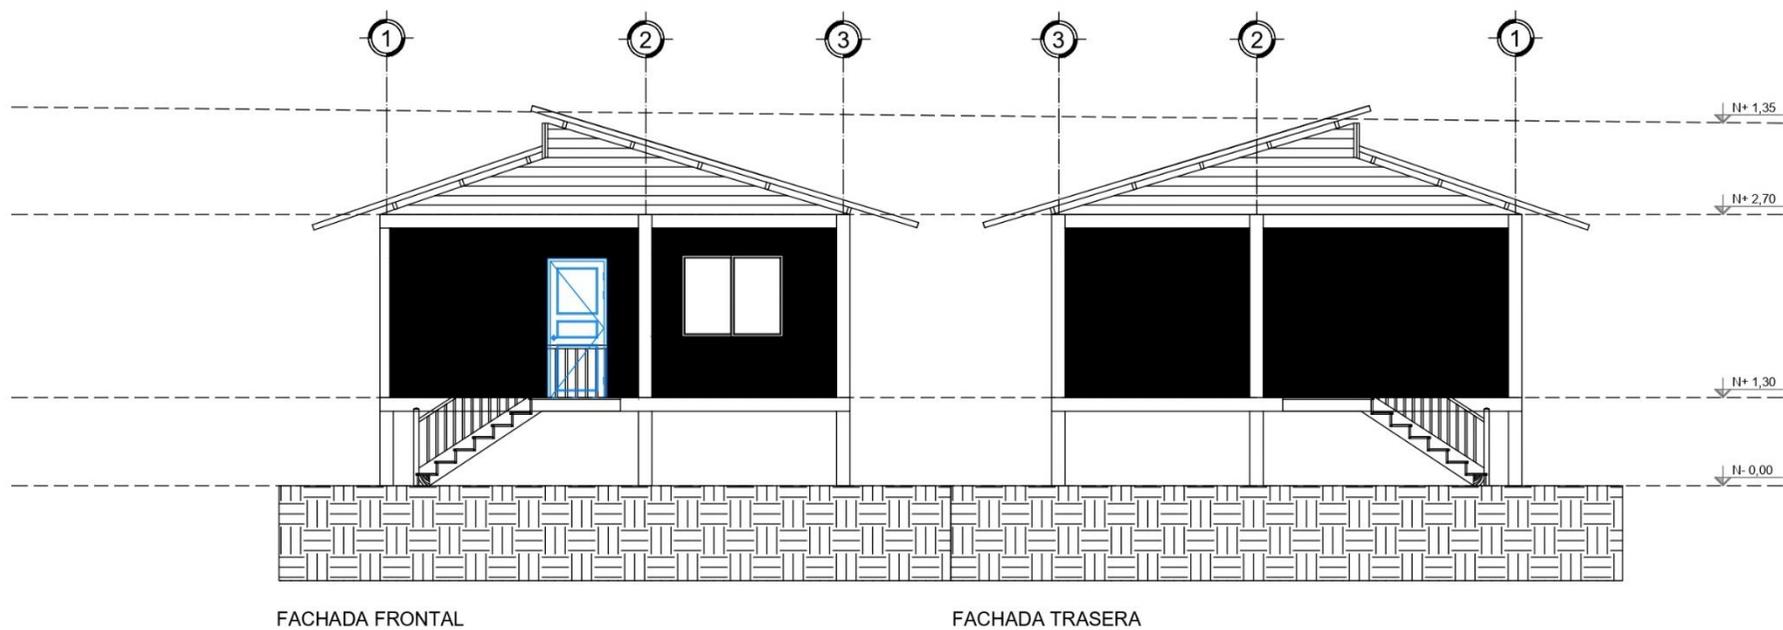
Fachada – Sección de prototipo de vivienda 1
